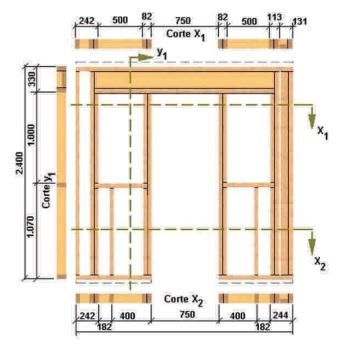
Tabique perimetral TSPp₂v₄ -2400x2360-(1).
